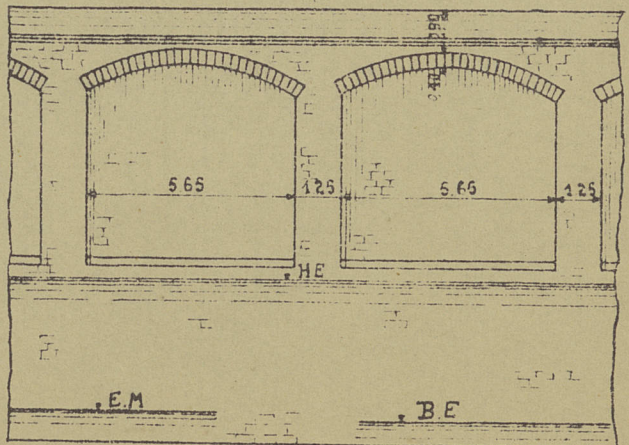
Coupe d'un mur à piliers et dalles en béton armé.
